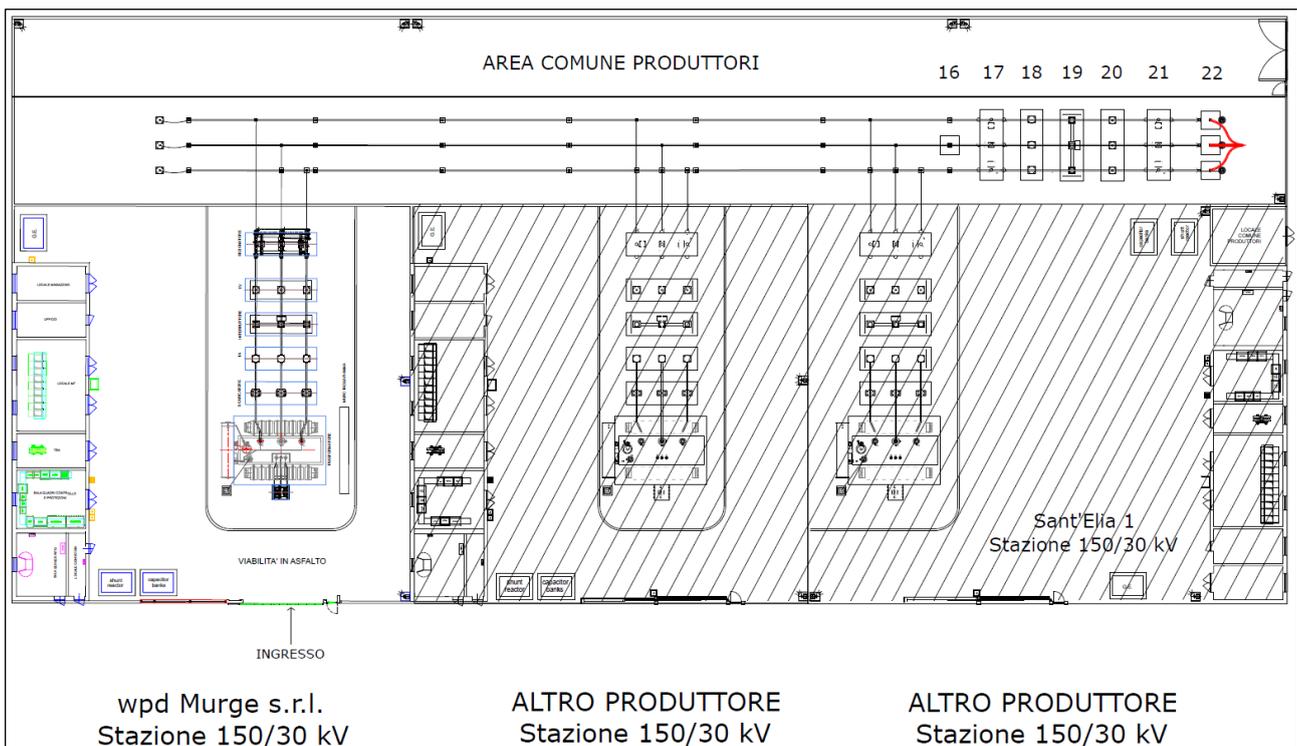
Planimetria elettromeccanica della Stazione Elettrica Utente 150/30 kV
